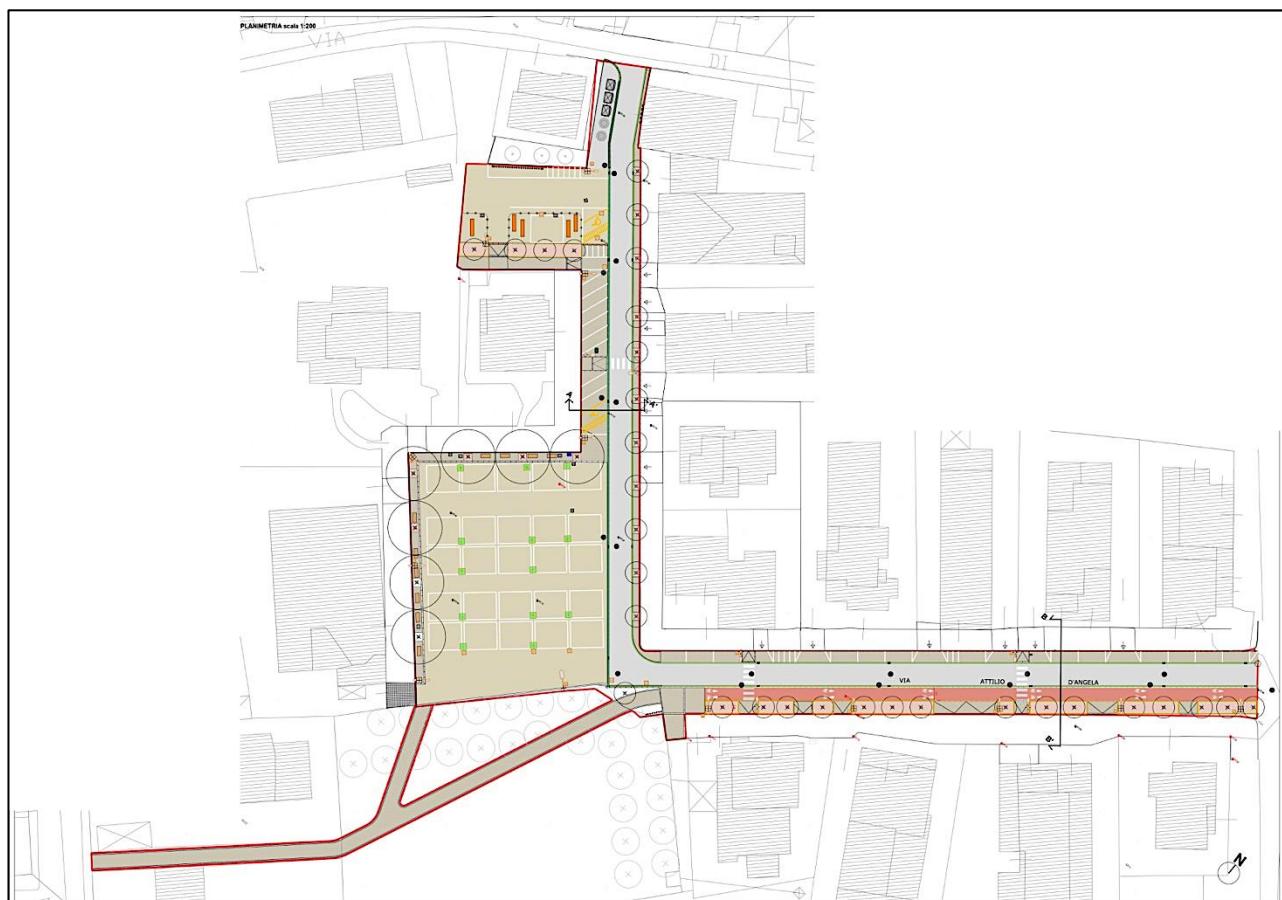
Estratto planimetria di progetto Piazza su via Attilio D'Angela
